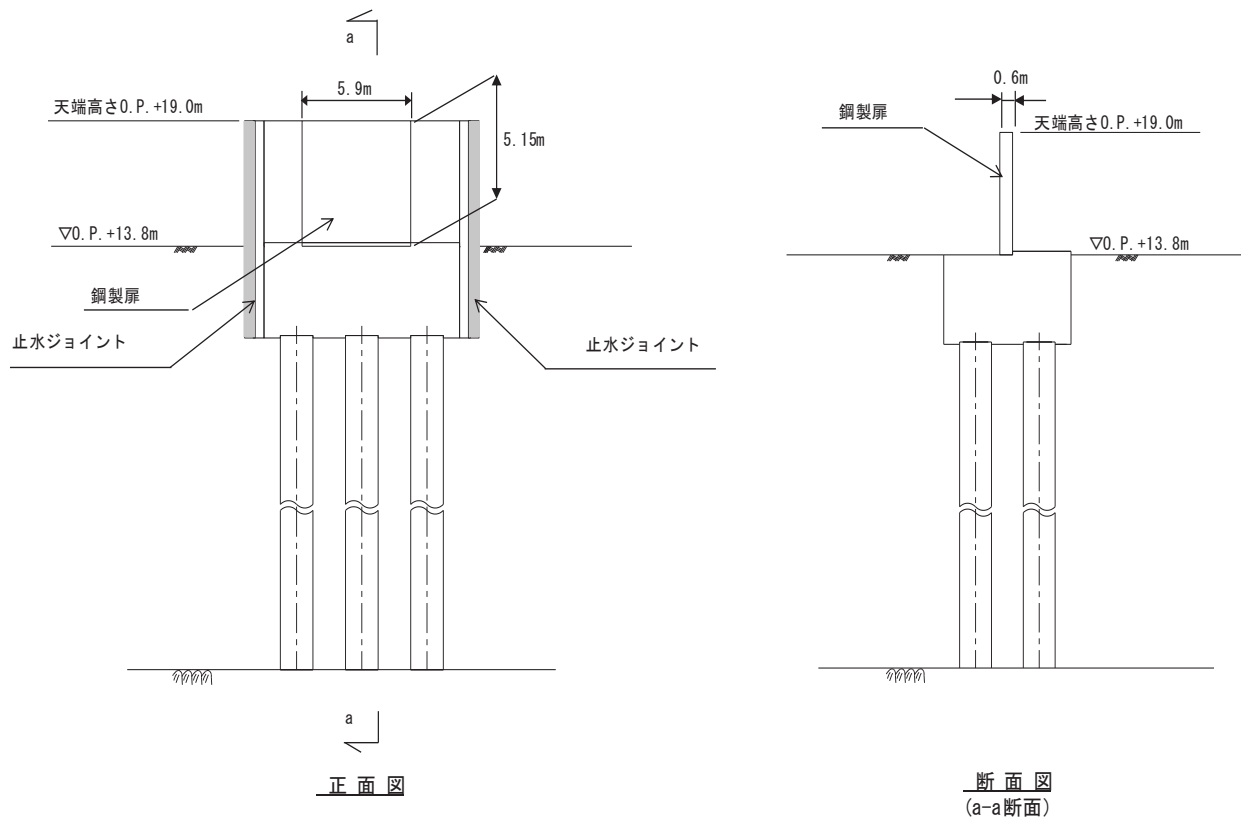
鋼製扉 1 正面図及び断面図
